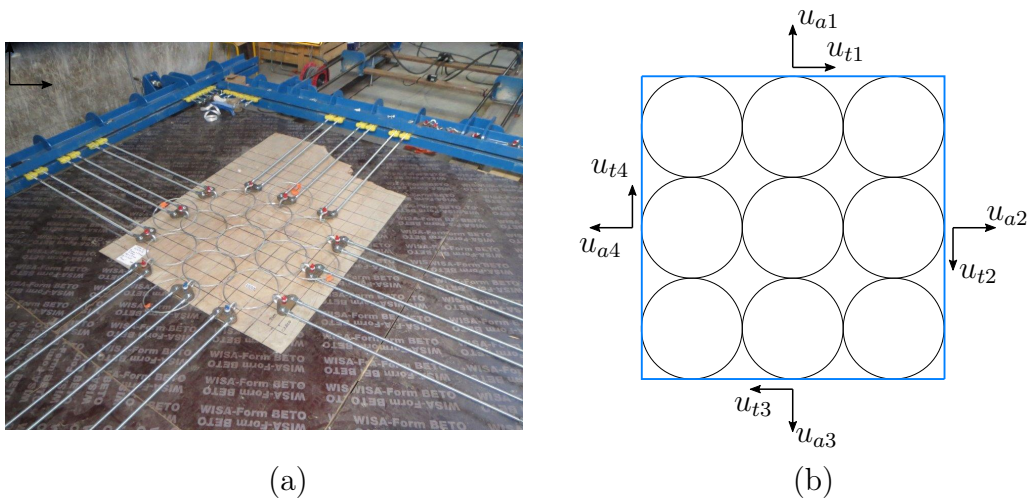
Test de traction plan sur une nappe d'anneaux : (a) photo du montage (source : C2ROP, NGE Fondations), (b) conditions aux limites
